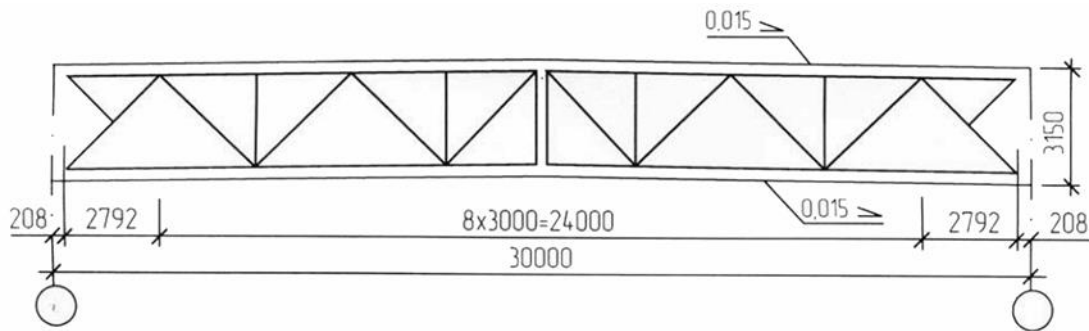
Схема типовой стропильной фермы из парных уголков пролетом 30 м
